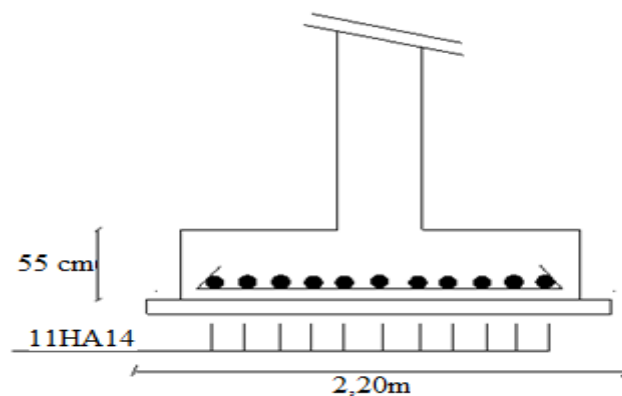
Ferrailage de la semelle intermédiaire dans le sens y-y.
